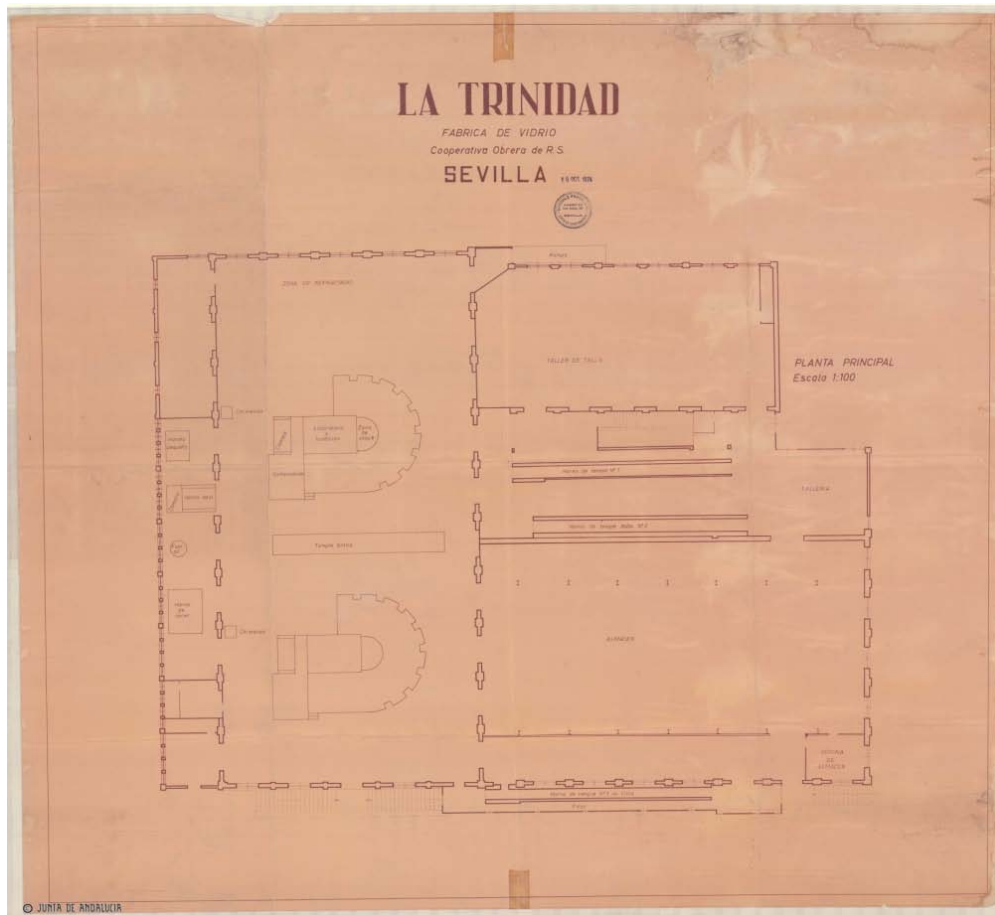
Distribución en planta. Primera Planta 1974
